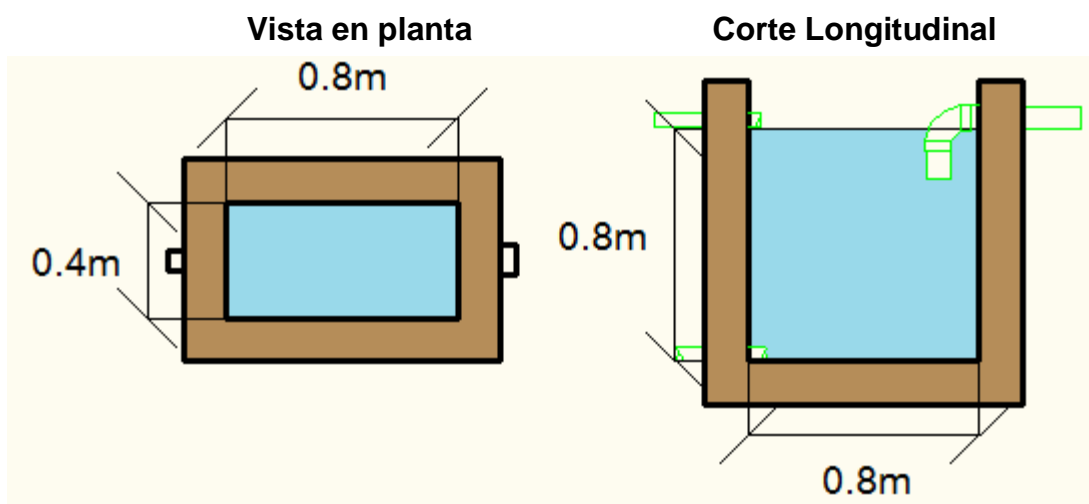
Vista planta y corte longitudinal del Sedimentador.
